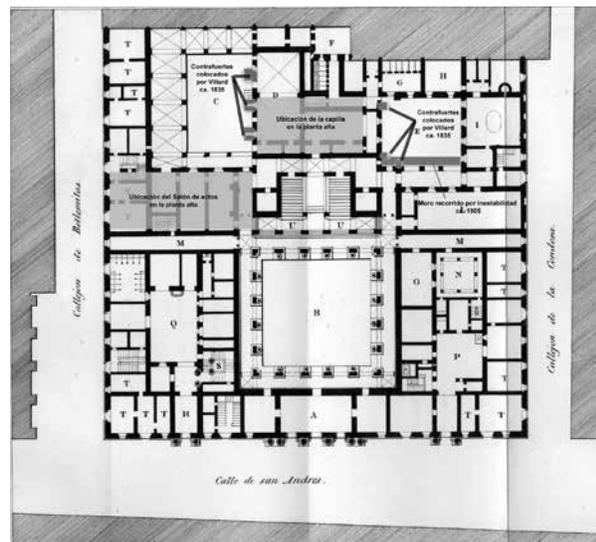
Planta baja del Palacio de Minería en 1841 según Castera. Obsérvese las ubicaciones de los salones de doble altura en la planta alta (figuras 3, 4 y 5) y las reparaciones estructurales posteriores. El norte está hacia abajo.
